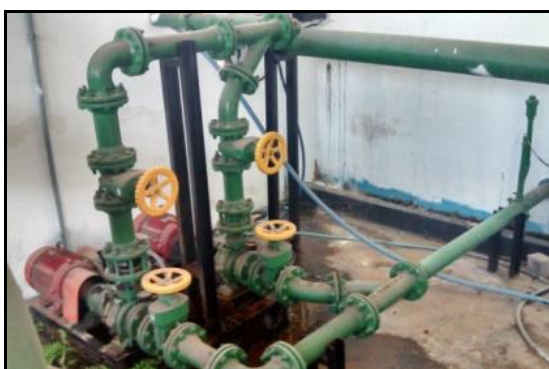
Vistas dos sistemas de bombeamento no interior da EEAT Palmeiras I.
